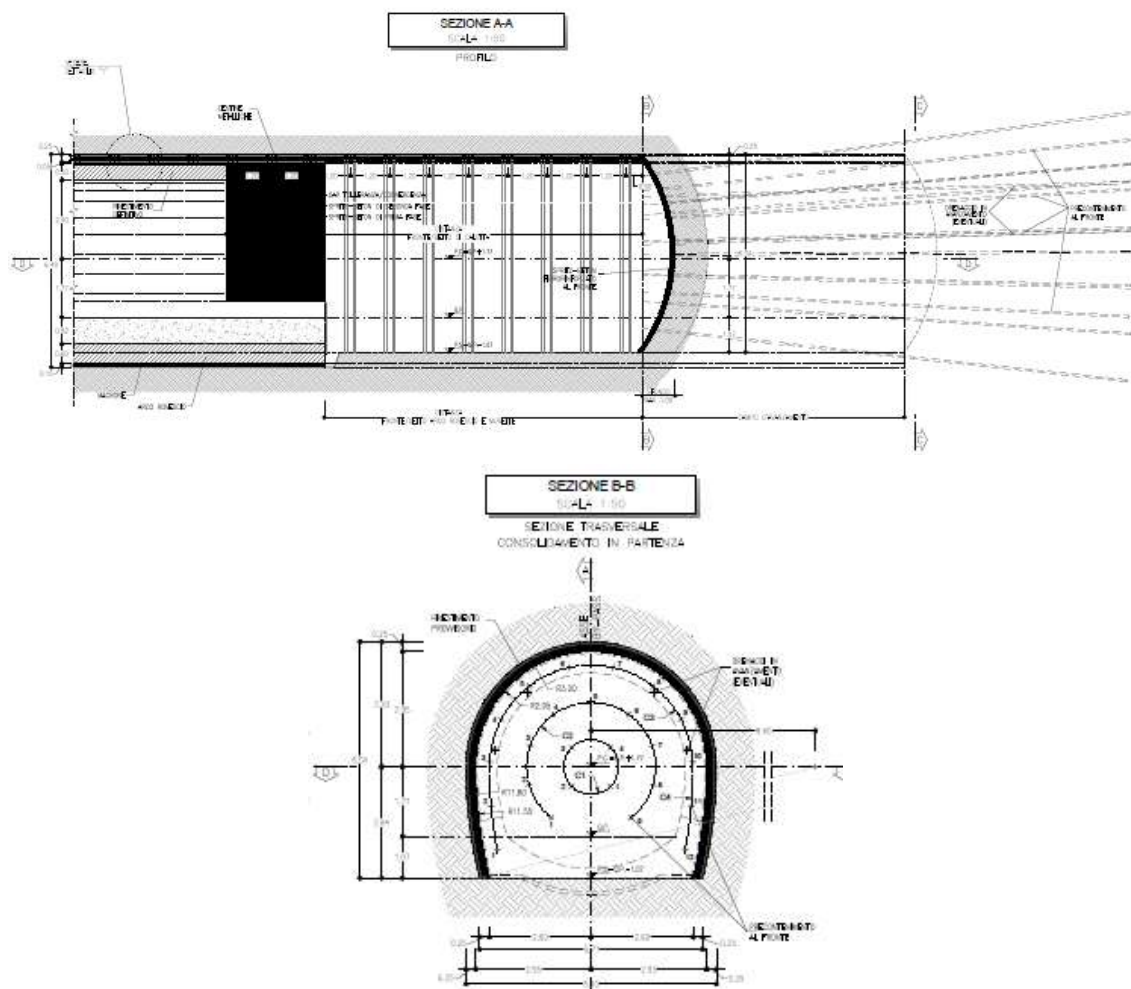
Sezione tipo B2 bypass area di sicurezza
